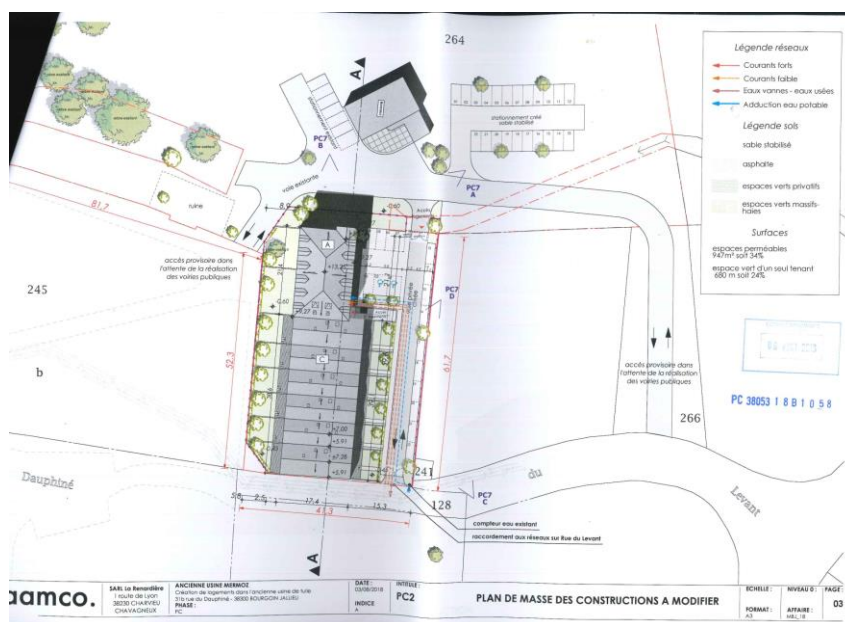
Plan masse des constructions à modifier des futurs bureaux et logements (Aamco, 2018)
